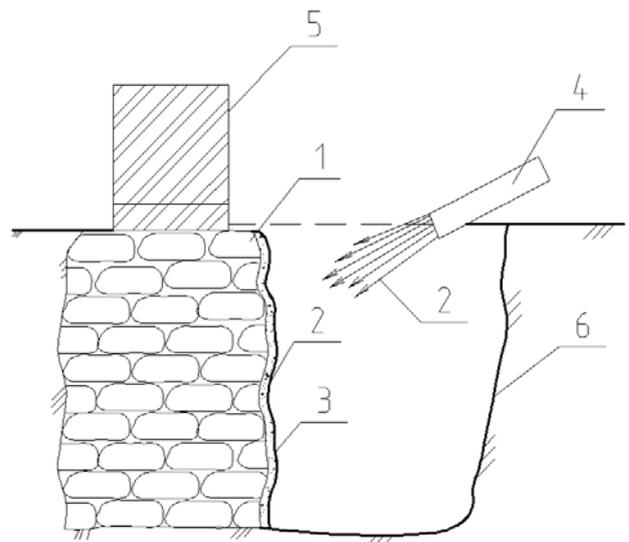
Закрепление бутовой (кирпичной) кладки фундамента торкрет-бетоном: 1 – существующий фундамент, имеющий расслоение бутовой (кирпичной) кладки; 2 – набрызг бетонной смеси под высоким давлением; 3 – торкретированная поверхность фундамента; 4 – цемент-пушка для набрызга бетонной смеси; 5 – кирпичная стена; 6 – вскрытый пазах фундамента
